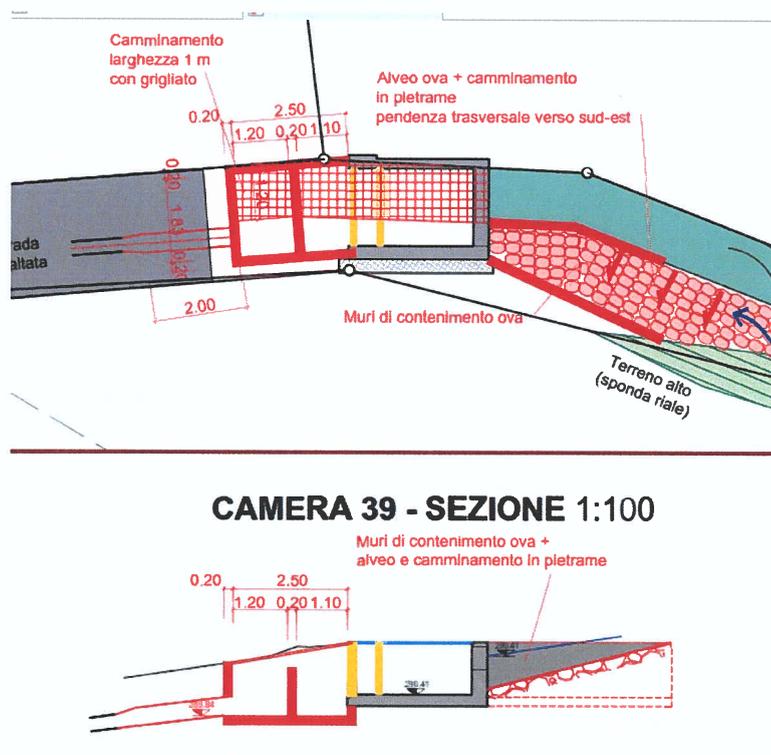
Estratto piano 030 Planimetria e sezioni camera 39
